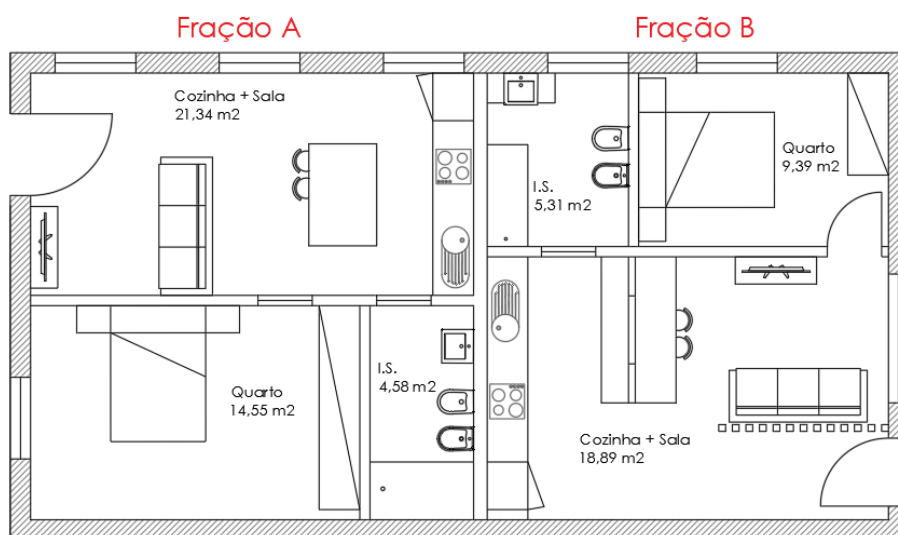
Planta de alteração do Piso 0 - Moradia principal
